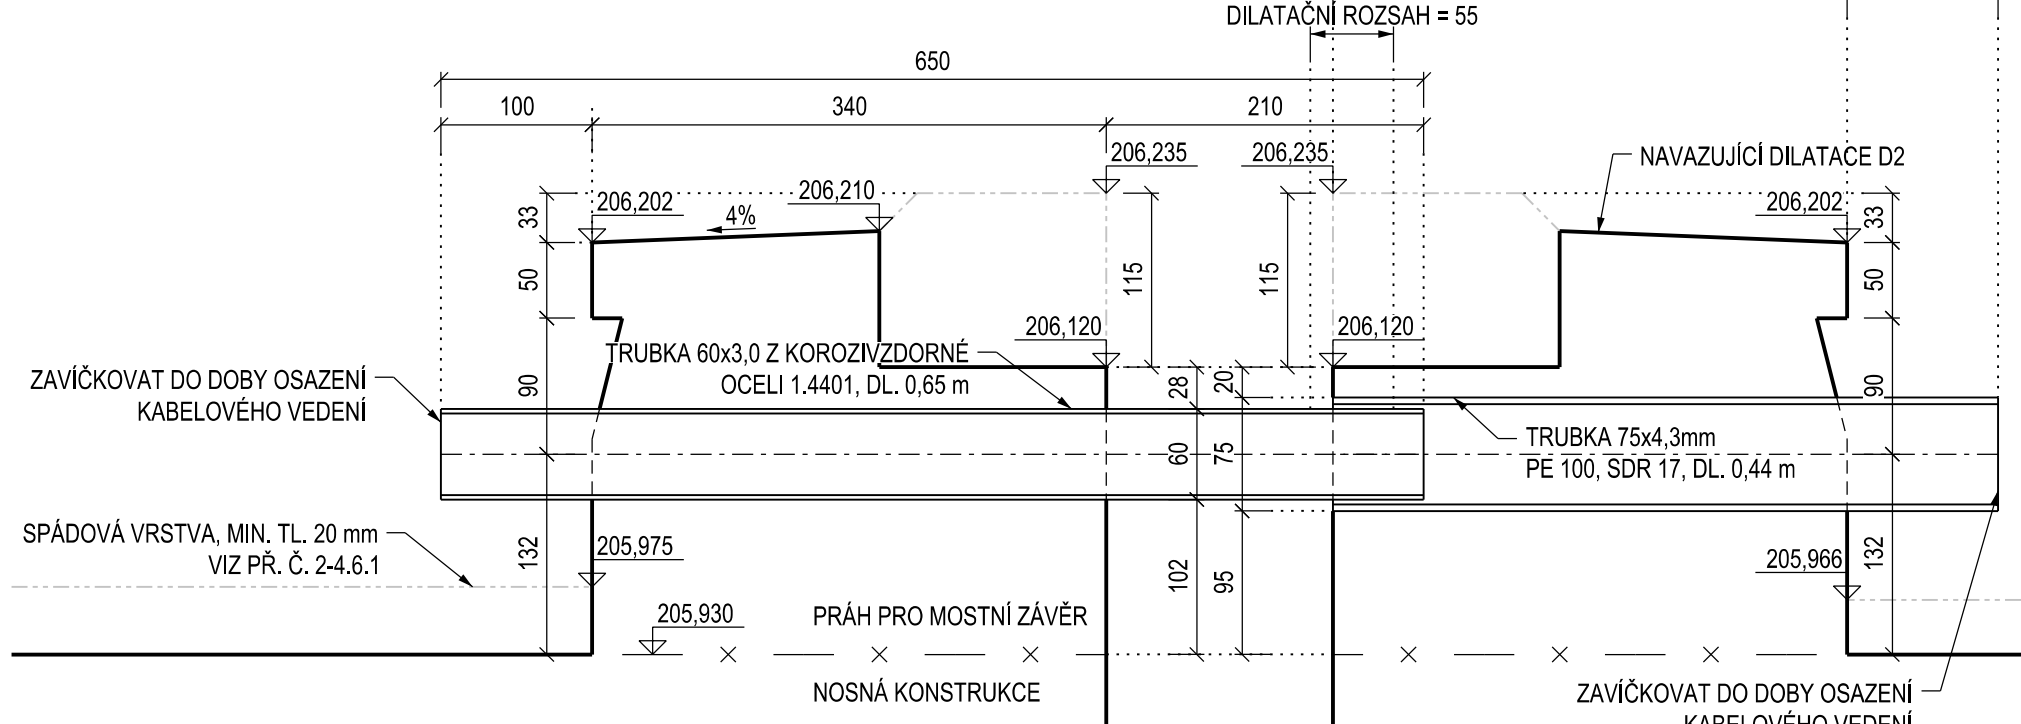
DETAIL I - PŮDORYS KAPSY PRO ESALÁTOR, 1:20
